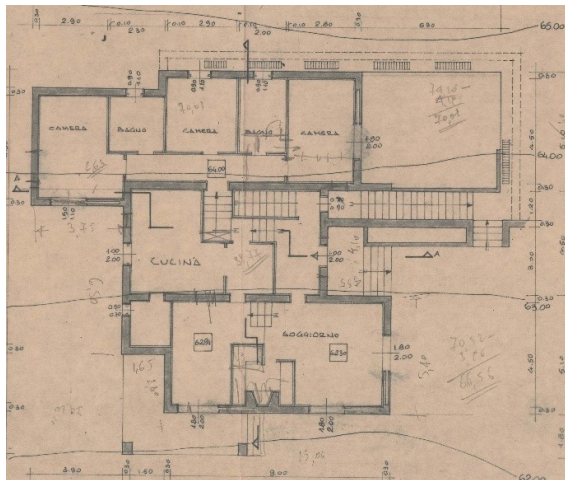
Stralcio C.E. 1147/89 – Piano terra
